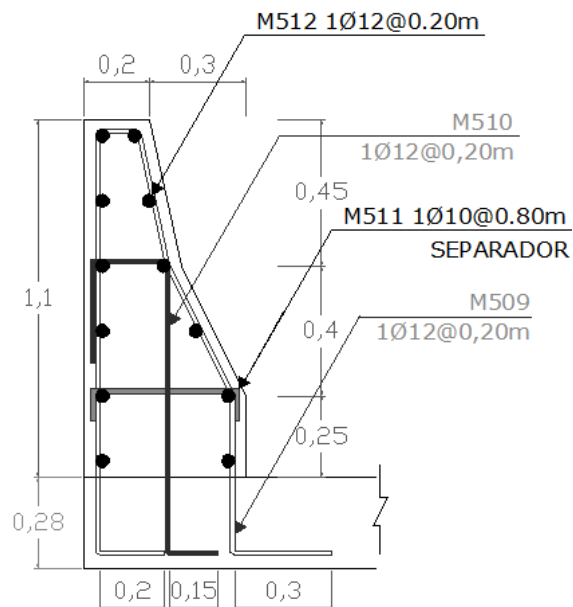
Esquema de armado y dimensionamiento de la protección lateral parapeto (PV-5)
